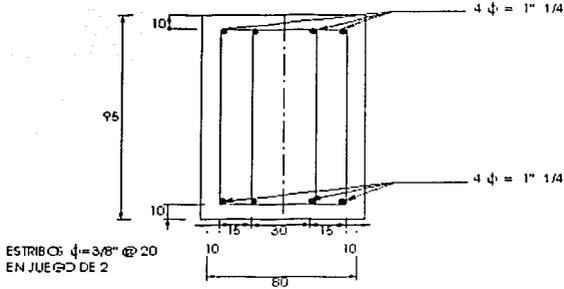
Croquis del Armado Propuesto de Ejes Transversales 1 a 9
